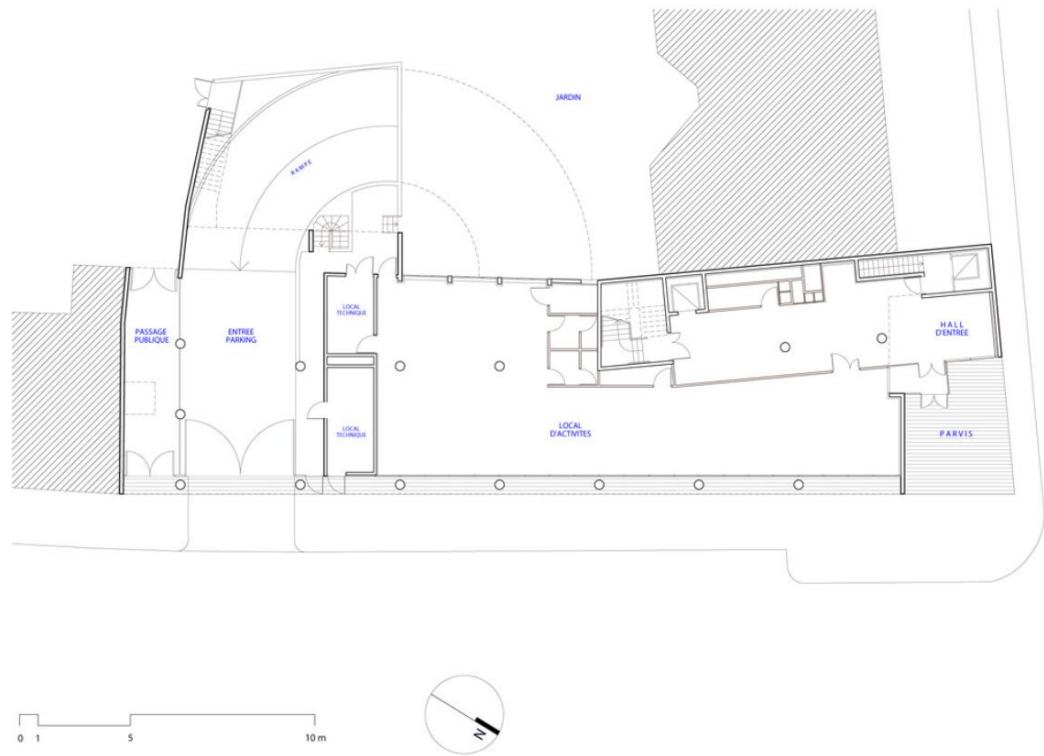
Planta arquitectónica del primer nivel del Centro Empresarial Gambetta, Francia. Recuperado de archdaily.pe
